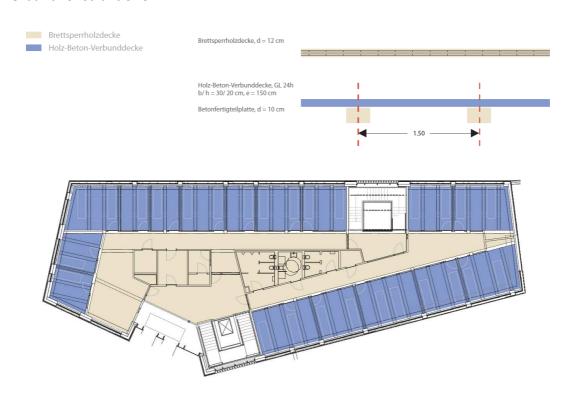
Aufbau der Geschossdecke über dem EG (IBUS Architekten)
